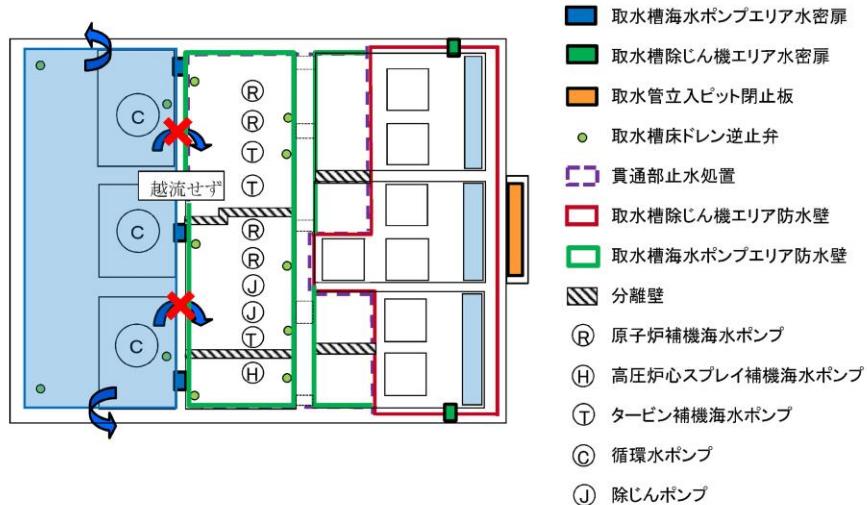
取水槽海水ポンプエリア平面図（循環水系配管破損時）
